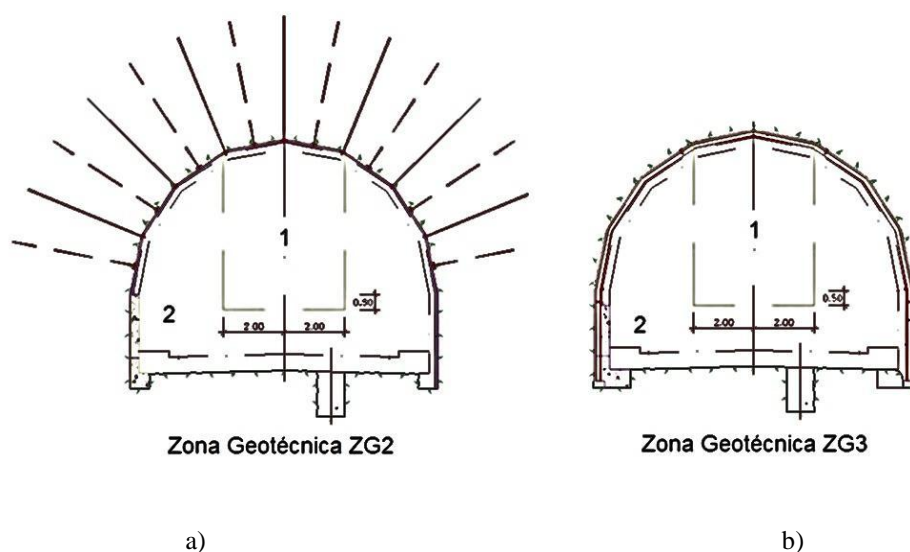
Faseamento de escavação a) Zona ZG2; b) Zona ZG3
